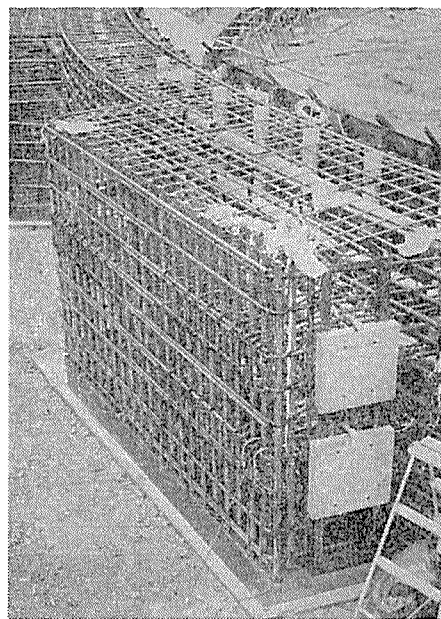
U試験体バットレス部配筋および支圧板取付けの状況
